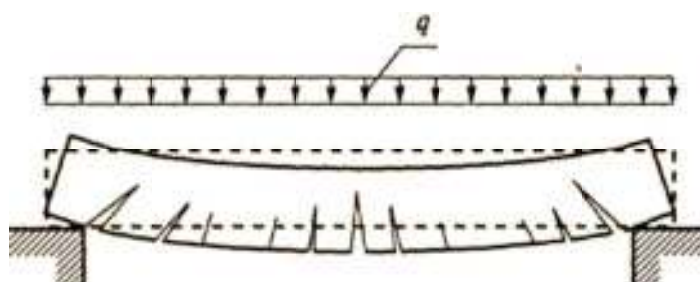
Схема разрушения железобетонной балки (арматура условно не показана)
